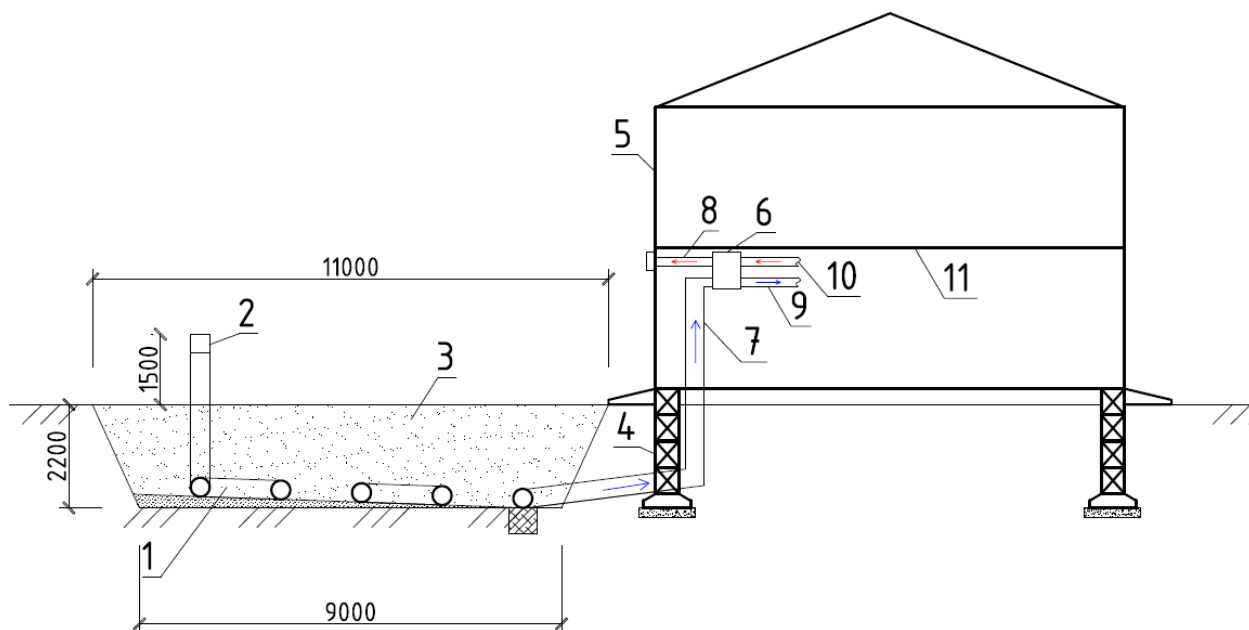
Теплогрунтообменник отдельно от фундамента здания, где: 1 – теплогрунтообменник; 2 – воздухозаборник; 3 – обратная засыпка; 4 – фундамент дома; 5 – частный дом; 6 – рекуператор; 7 – подача воздуха; 8 – выброс вытяжного воздуха; 9 – свежий приточный воздух; 10 – вытяжной воздух; 11 – уровень потолка 1 этажа дома
